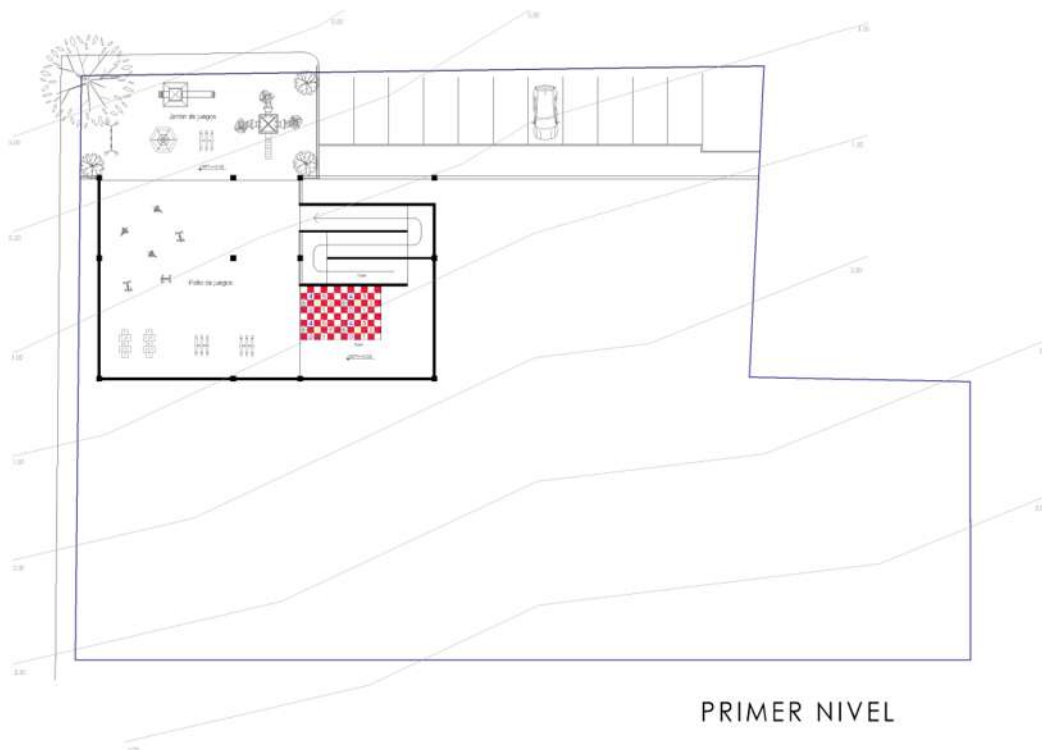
Segunda propuesta arquitectónica, primer nivel
